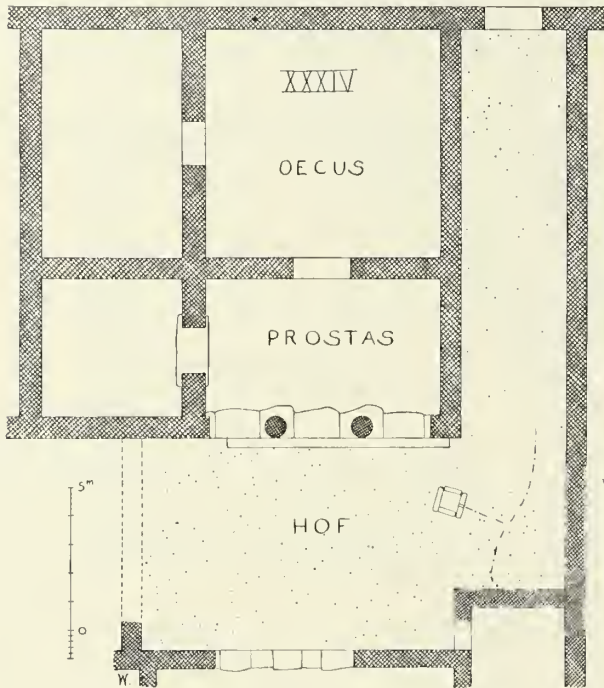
Grundriss des Hauses Nr. XXXIV.
